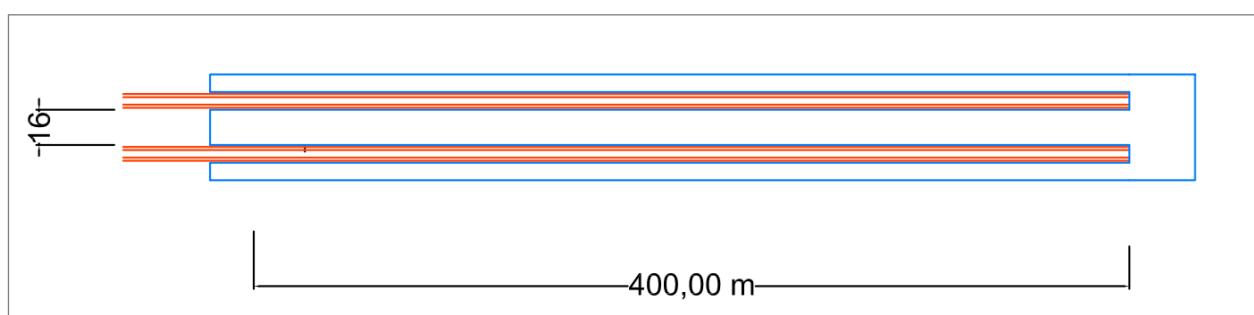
Proposta para layout de estação do tipo “Terminal”.
